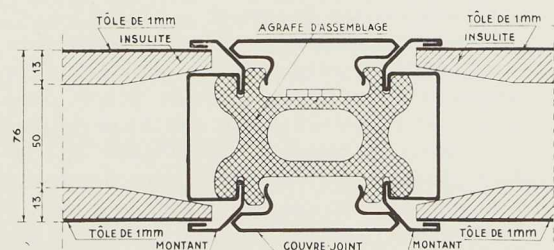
Coupe d'une cloison au droit d'un assemblage.
